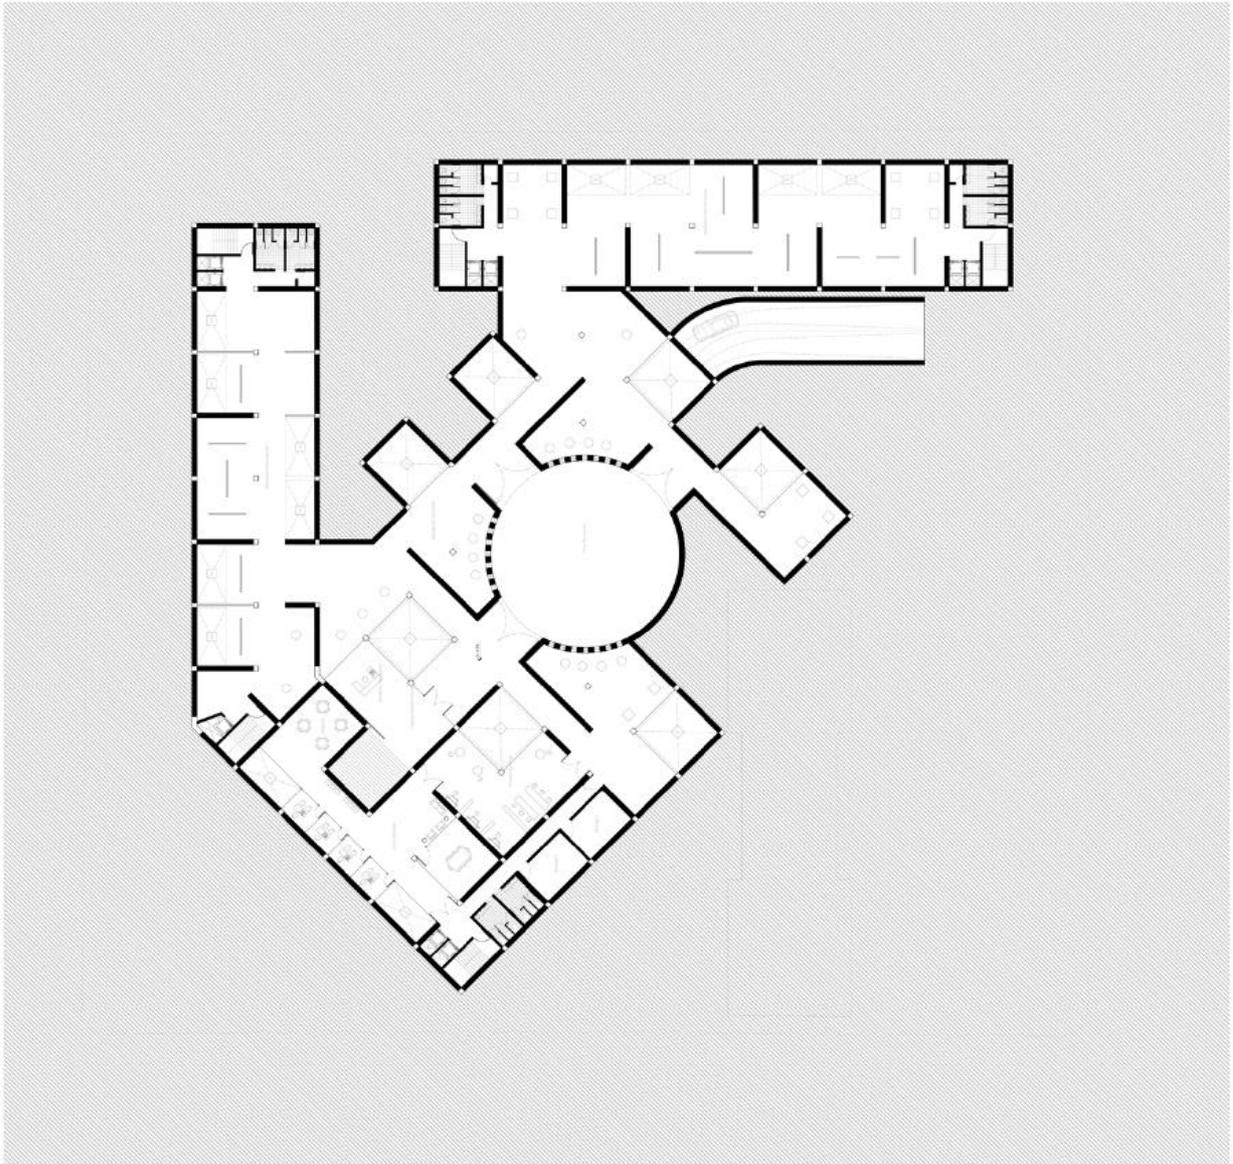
Planta Galería / Museo. Nivel - 4.00
